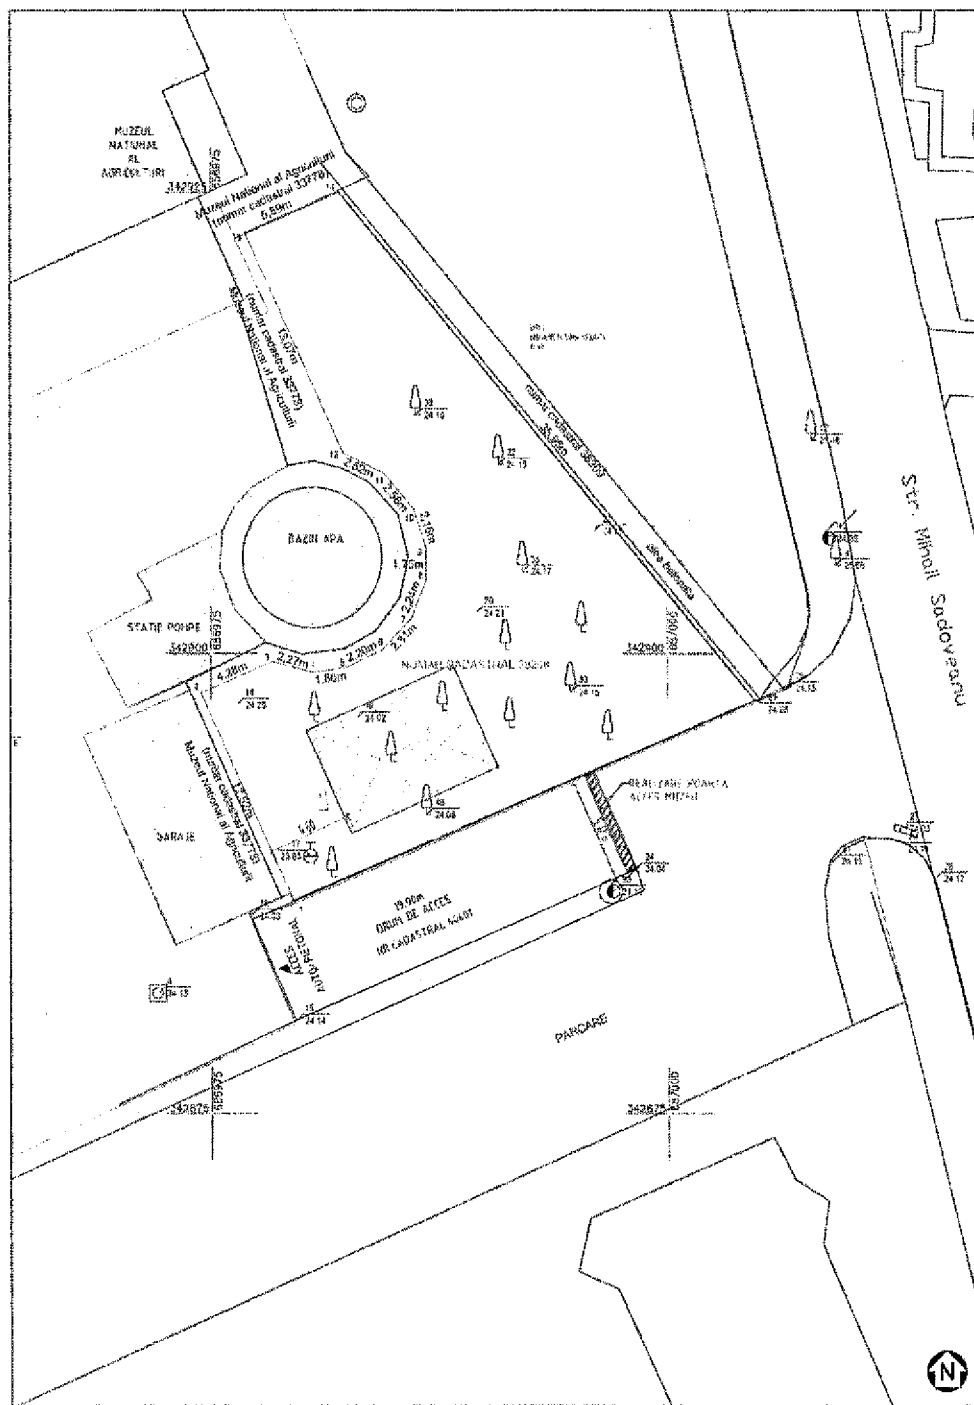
Plan de situație – Ampiasare Poarta de acces muzeu
